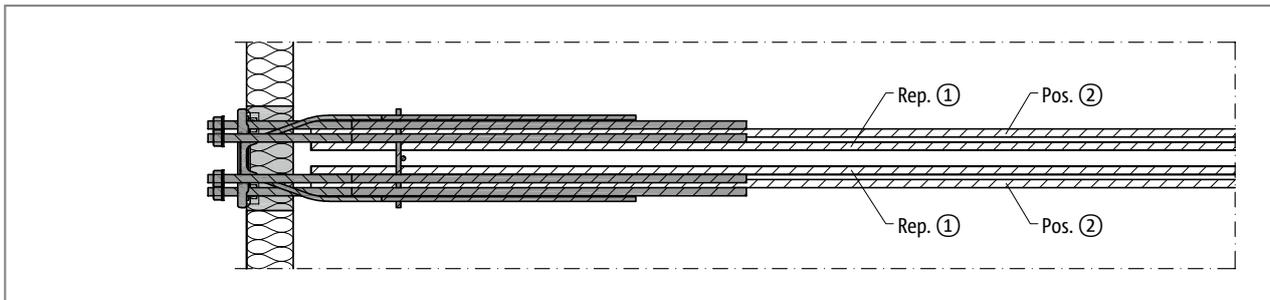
Schöck Isokorb® T type SK-MM1 : renforcement sur site, plan de base
